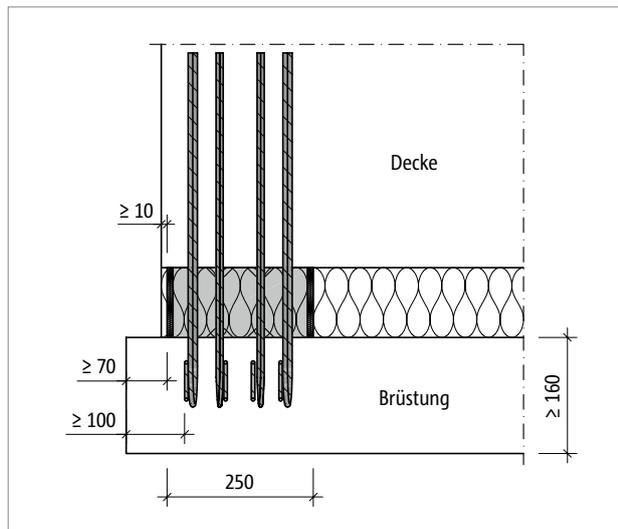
Schöck Isokorb® XT/T Typ F: Ansicht Randabstände
